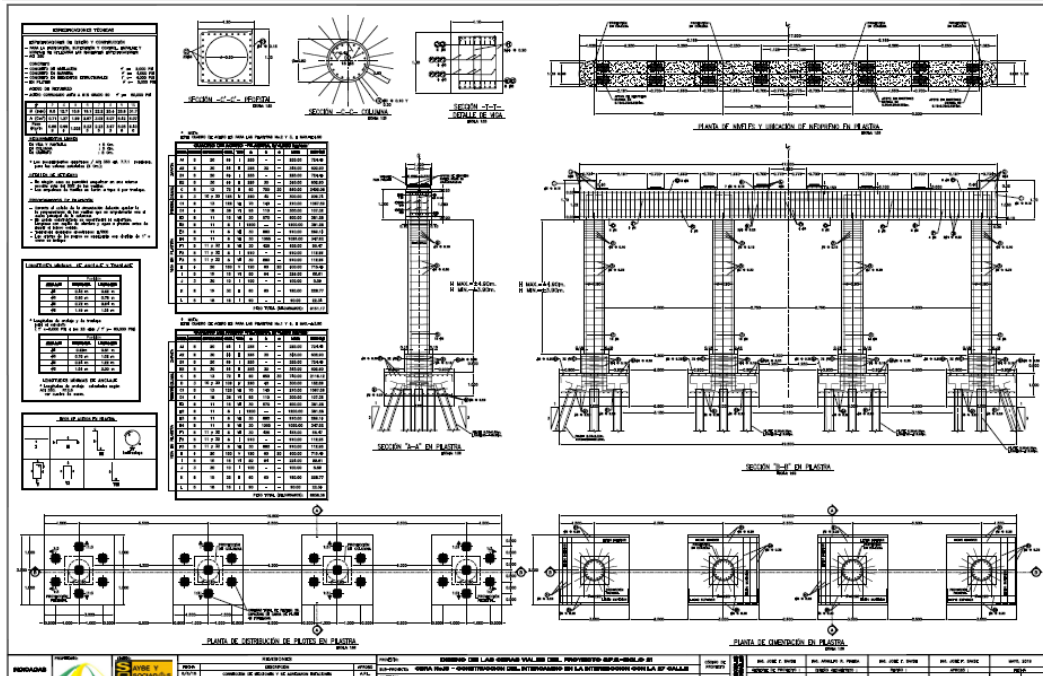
Plano Estructural EST-12, Detalles de Pilastra.
